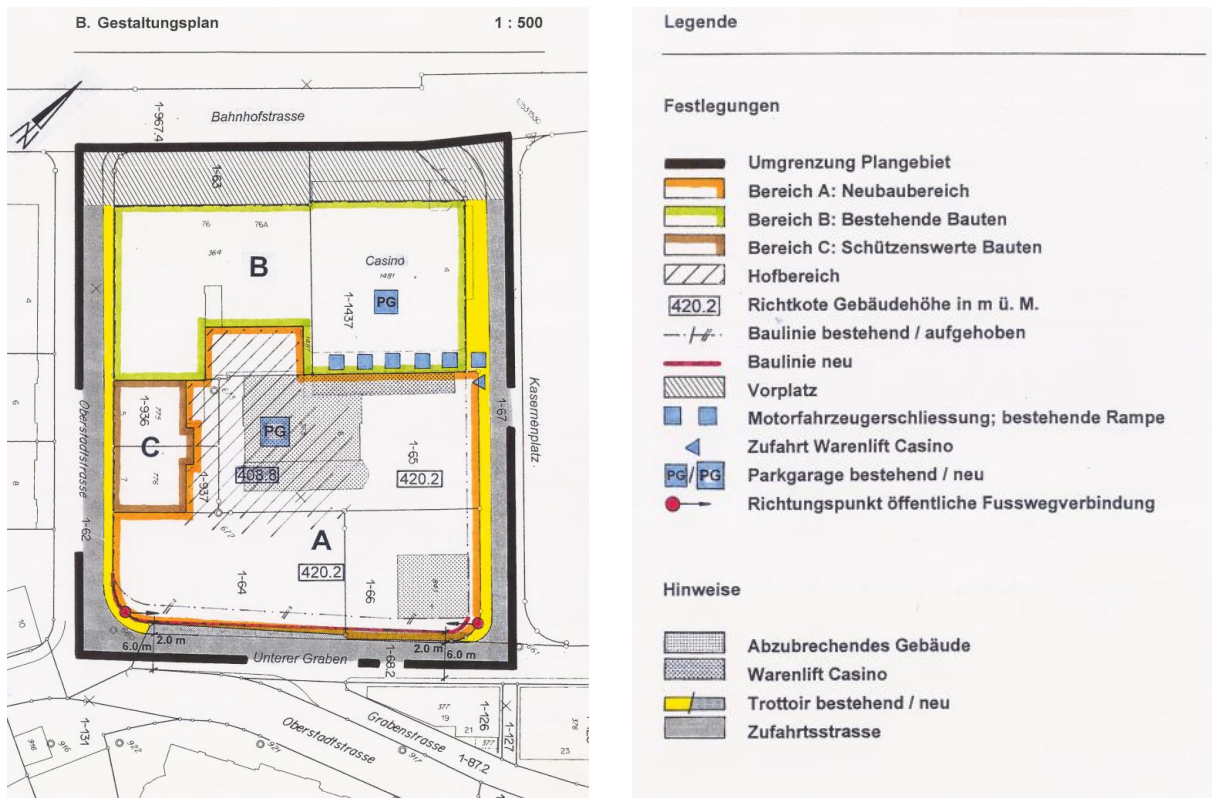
Gestaltungsplan 1998, Situationsplan mit Legende
